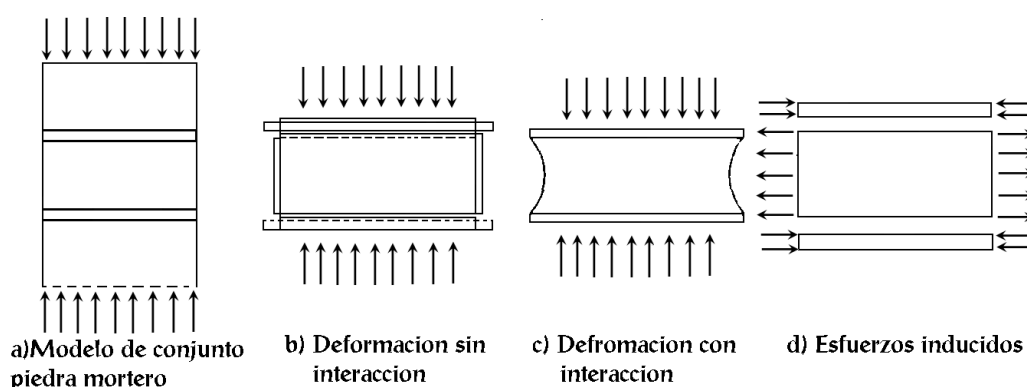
Modelo simple de interacción piedra-mortero en la mampostería
